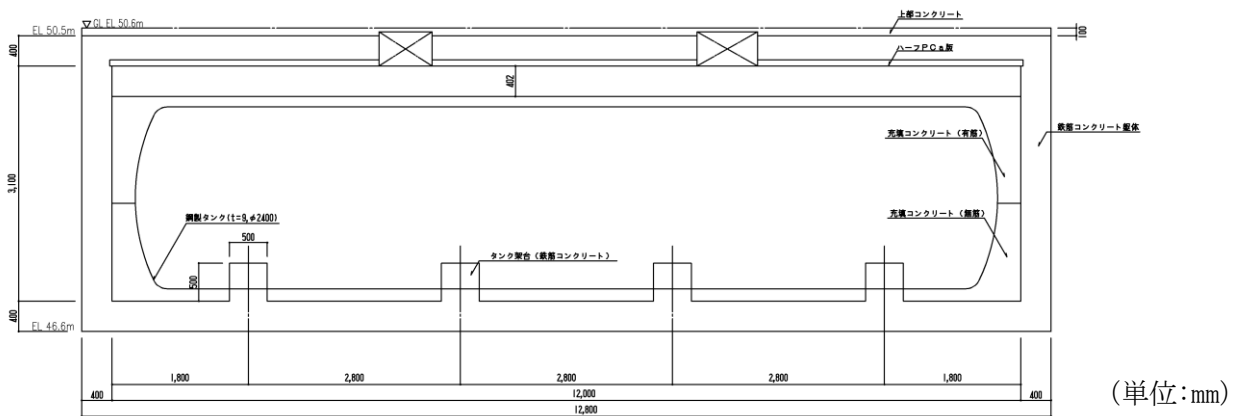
緊急時対策所用燃料地下タンク 平面図 (単位:mm)
